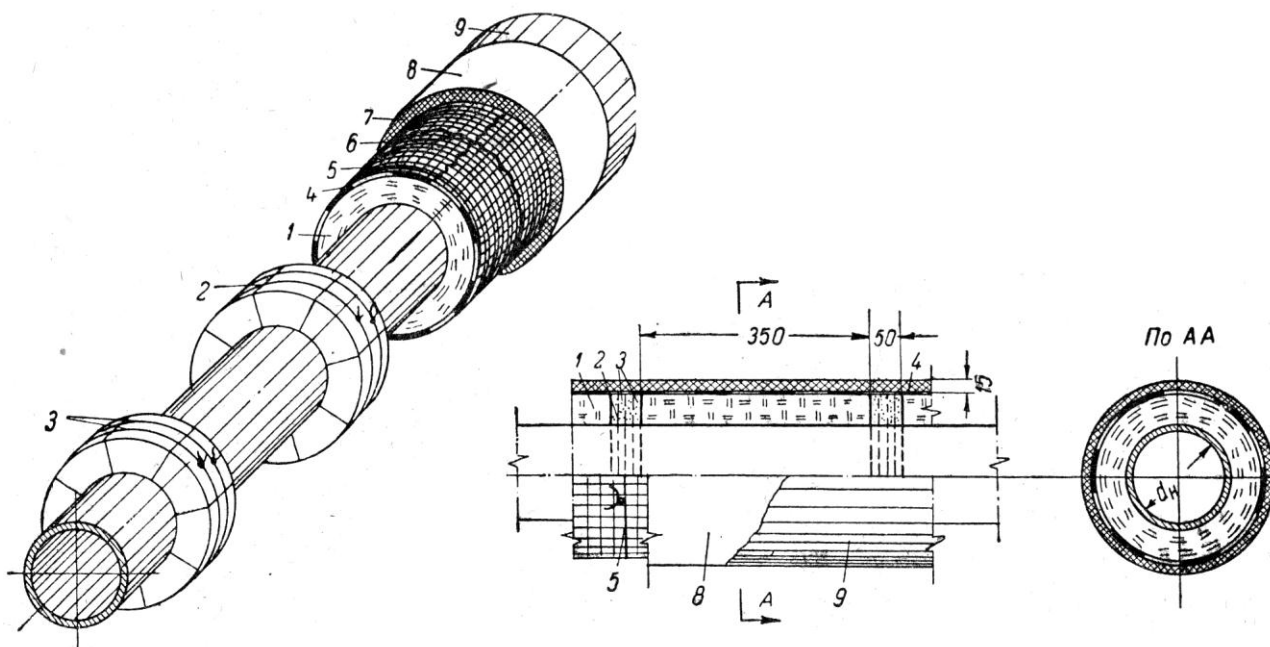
Тепловая изоляция трубопроводов минеральной ватой
